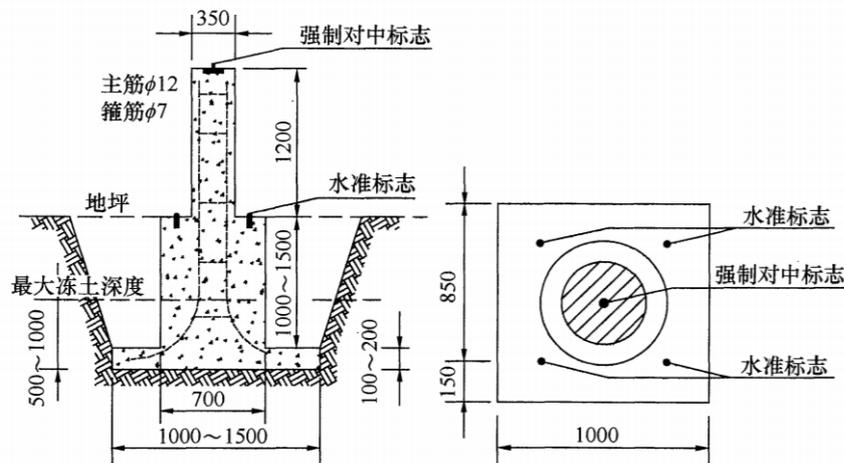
土层水平位移观测墩剖面图与俯视图（单位：mm）
